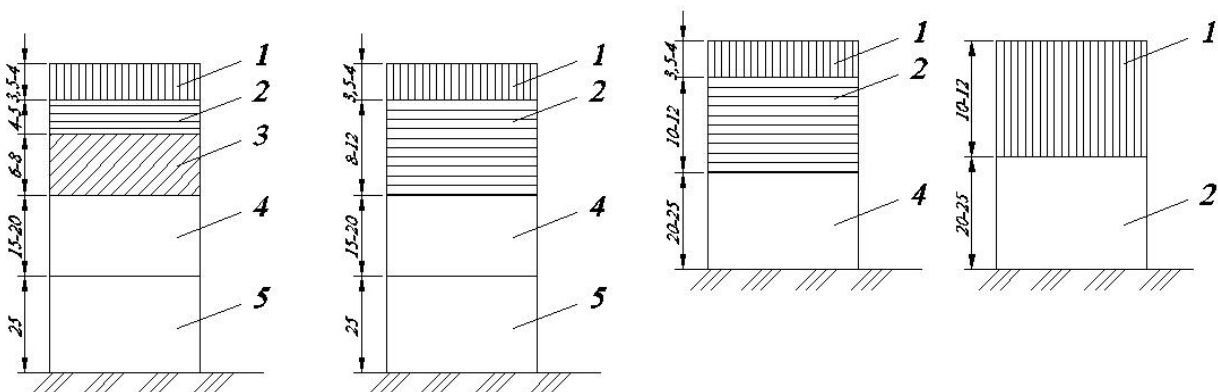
Конструкция дорожной одежды с асфальтобетонными покрытиями (размеры в см): 1 – верхний слой покрытия; 2 – нижний слой покрытия; 3 – верхний слой основания; 4 – основание; 5 – дополнительный слой основания
